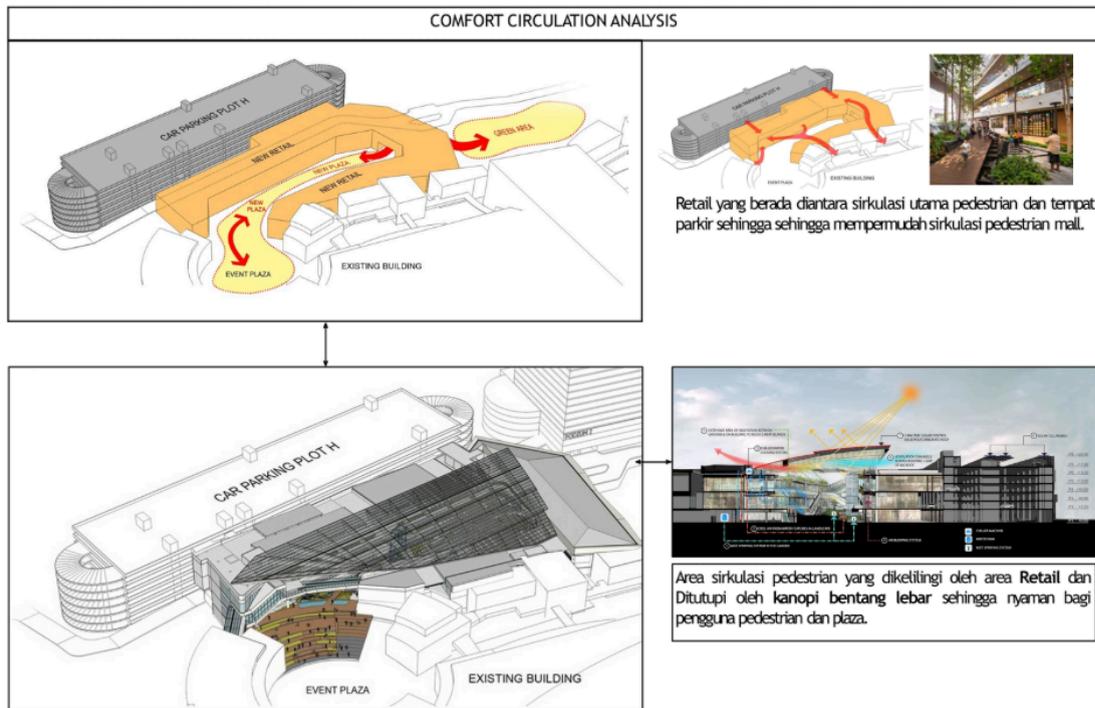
Gambar Akses Mega Food Walk
